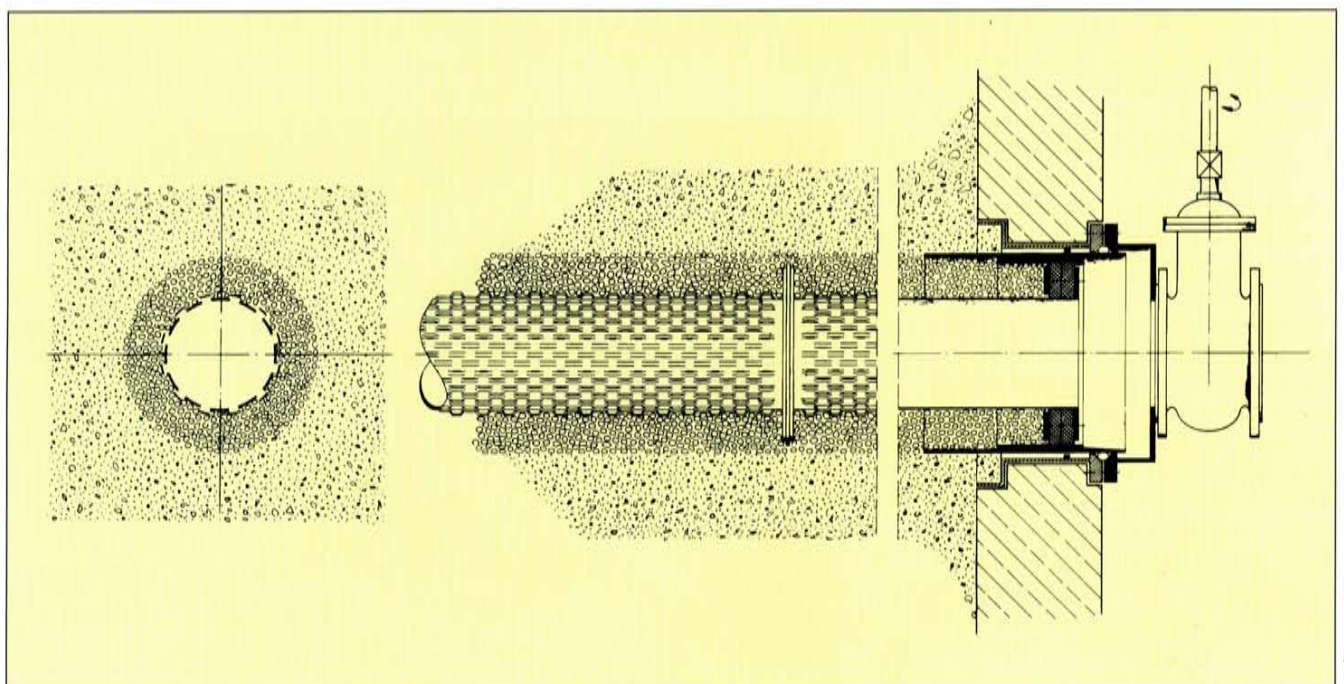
Horizontaler Brunnenstrang mit Kiesummantelung (Ausschnitt)
